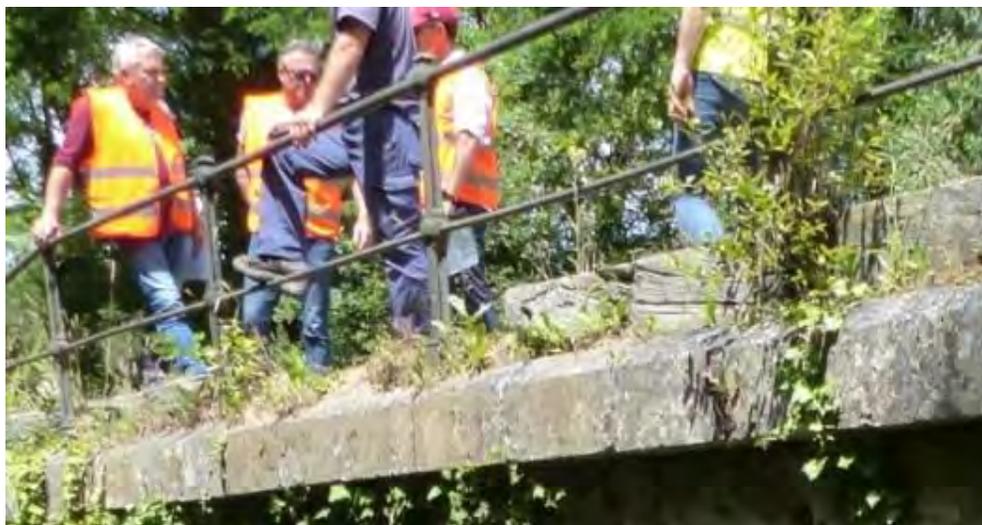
Plinthe et garde-corps sur le pont sur le Luzou.
